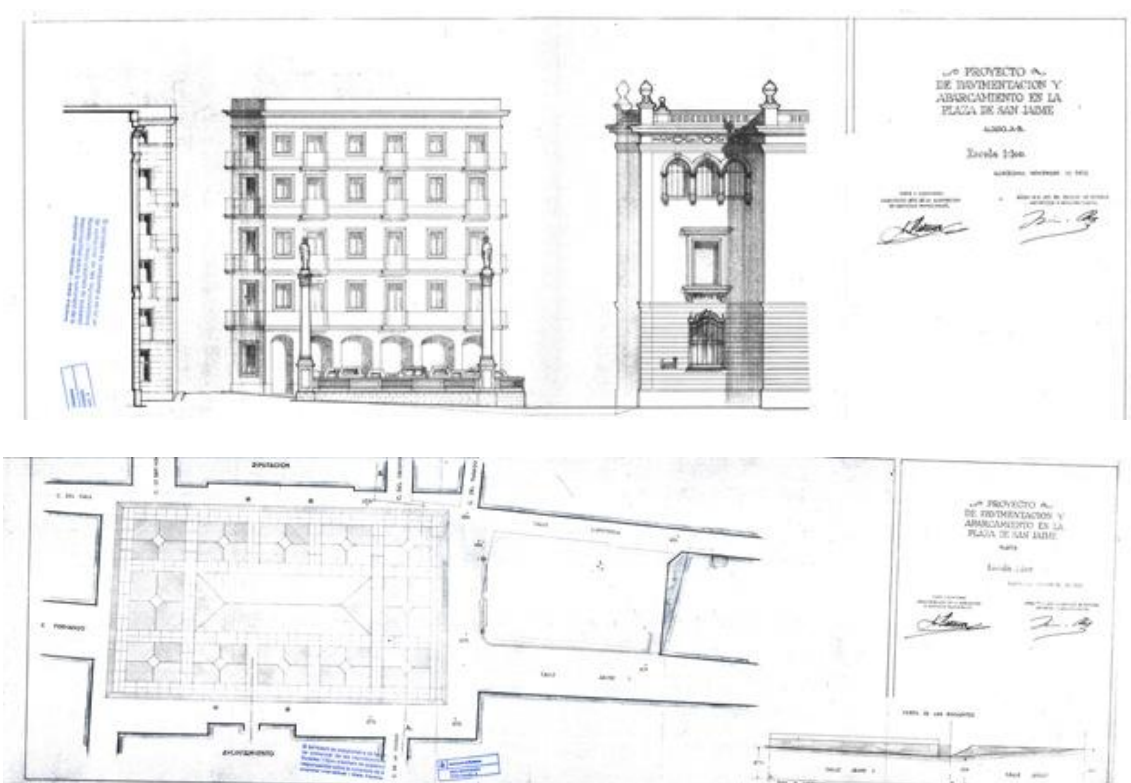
> Proyecto de pavimentos y aparcamiento en la plaza de Sant Jaume, Adolf Florensa, noviembre 1953 (AMCB 1951)
